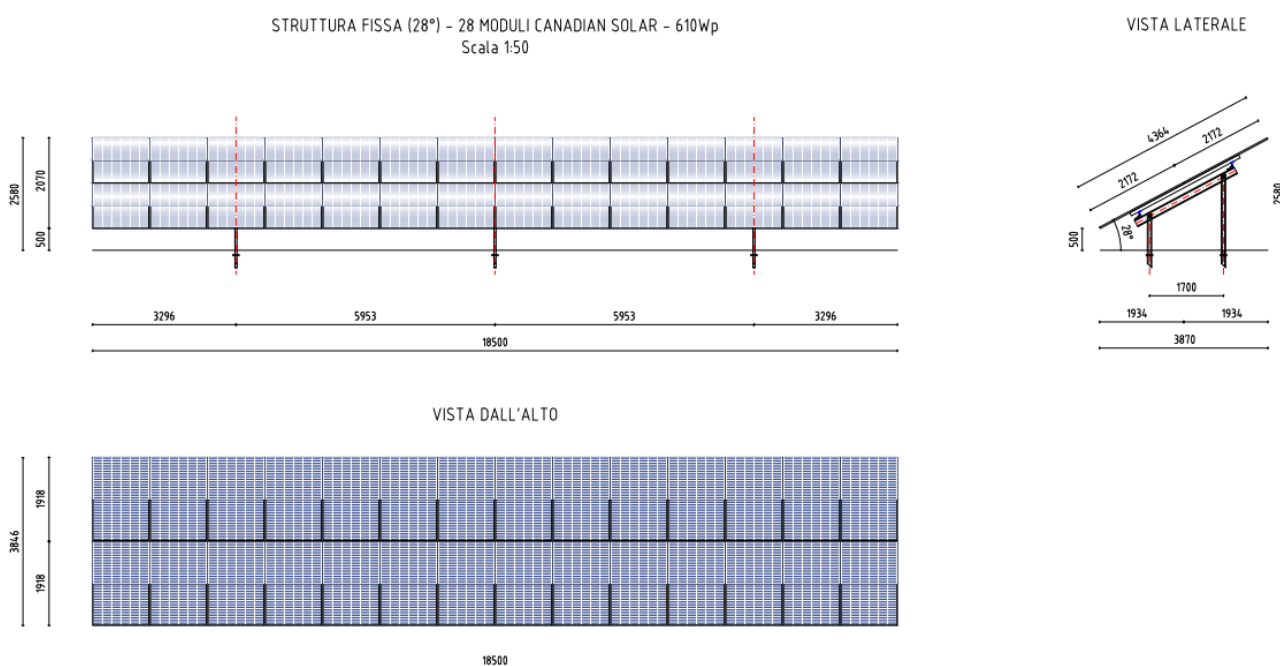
Tipico struttura supporto pannelli di tipo fisso
